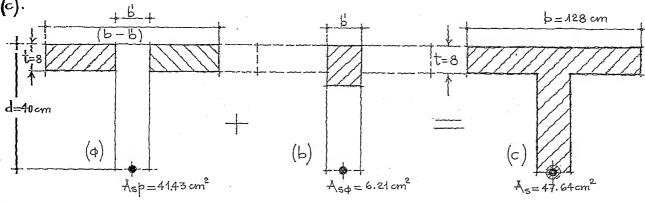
Colocación del acero en la viga "t,"(d).
